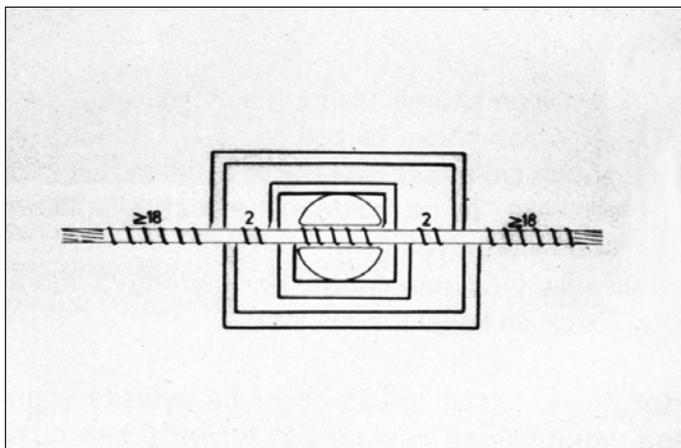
Схема крепления провода в верхний желоб изолятора.
